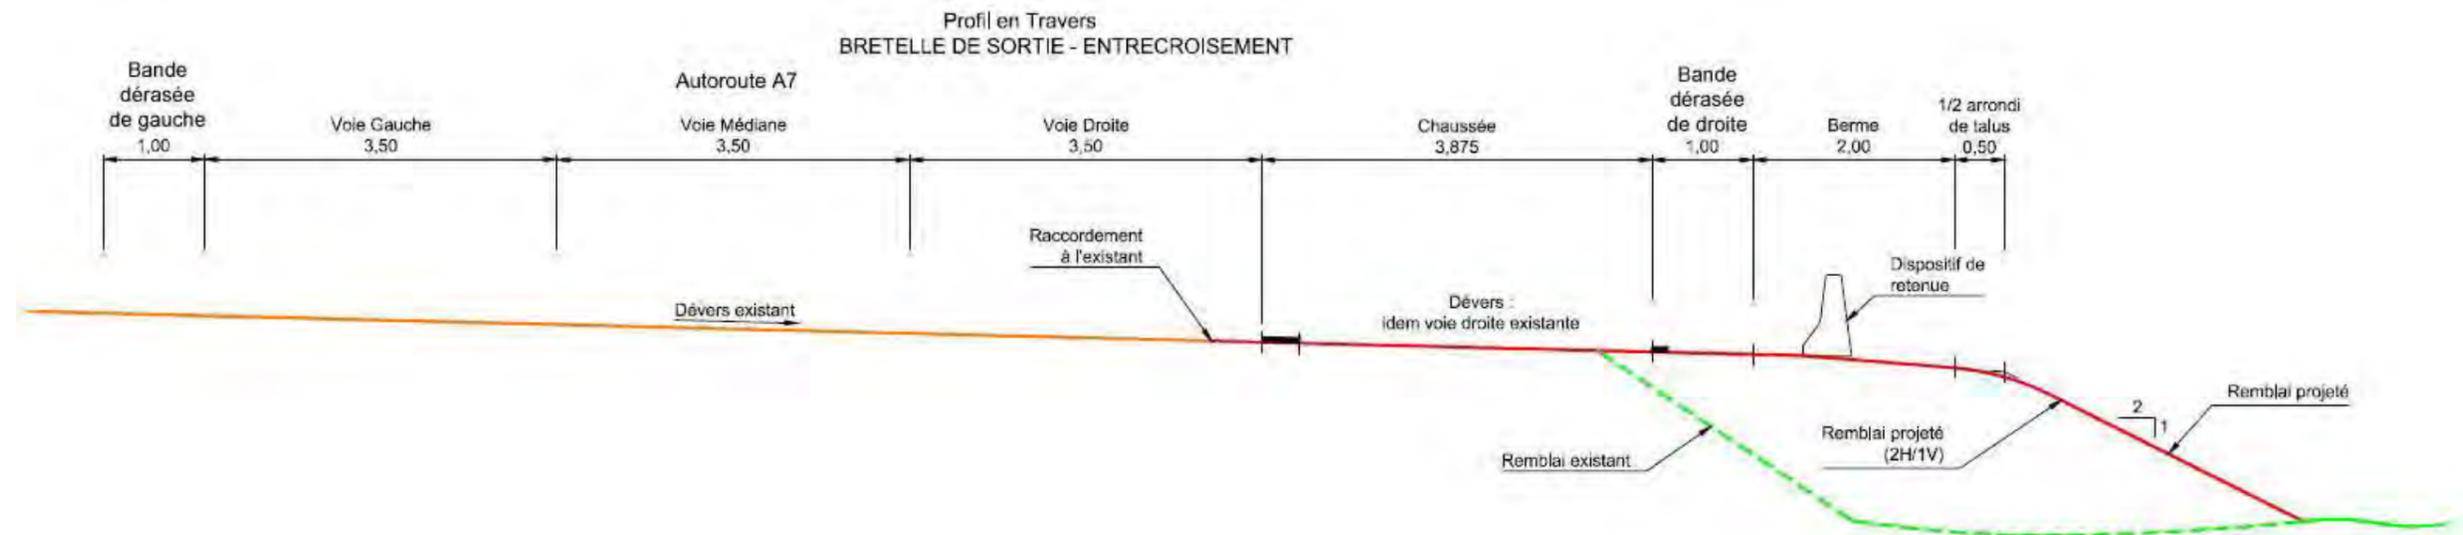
Profil en travers type au niveau de la voie d'entrecroisement
